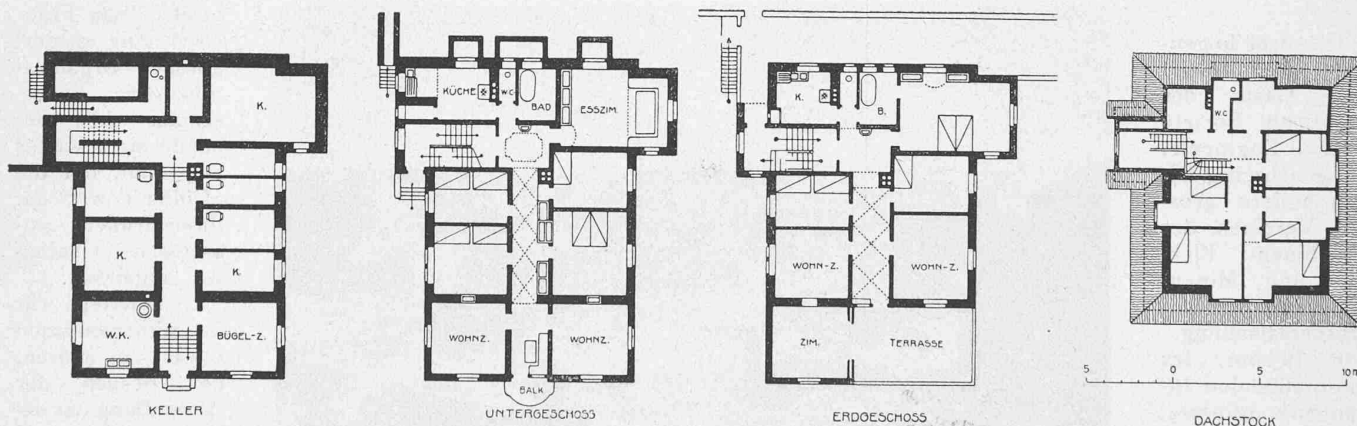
bis 8. Grundrisse (1:400) des Mehrfamilien-Wohnhauses Titlisstrasse 60 in Zürich. — Oben: Abb. 10 Südost-Ansicht; Abb. 11 Südwest-Ansicht.
